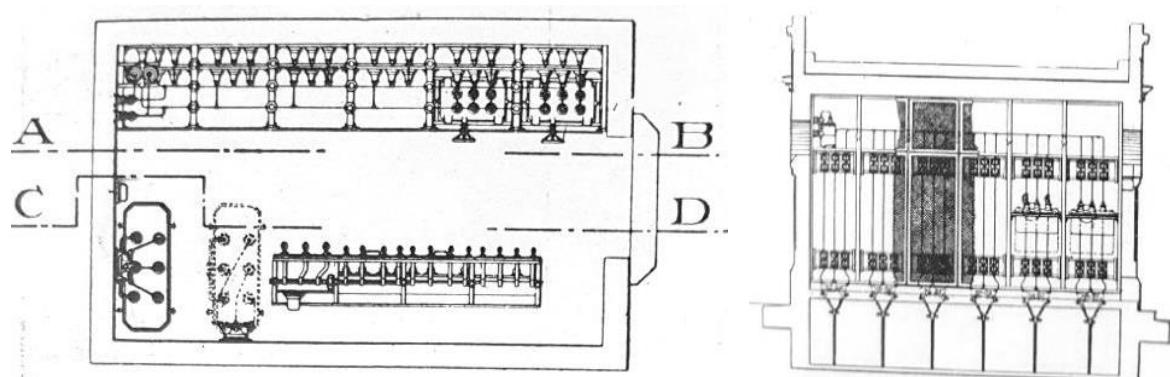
, 16 Planta y corte de subestación / Substation floorplan and section (reproducido de/ reproduced from: Gache, Ernesto (junio 1920). Las instalaciones de la C.I.A.E. Revista Bios. 28 – 30)
